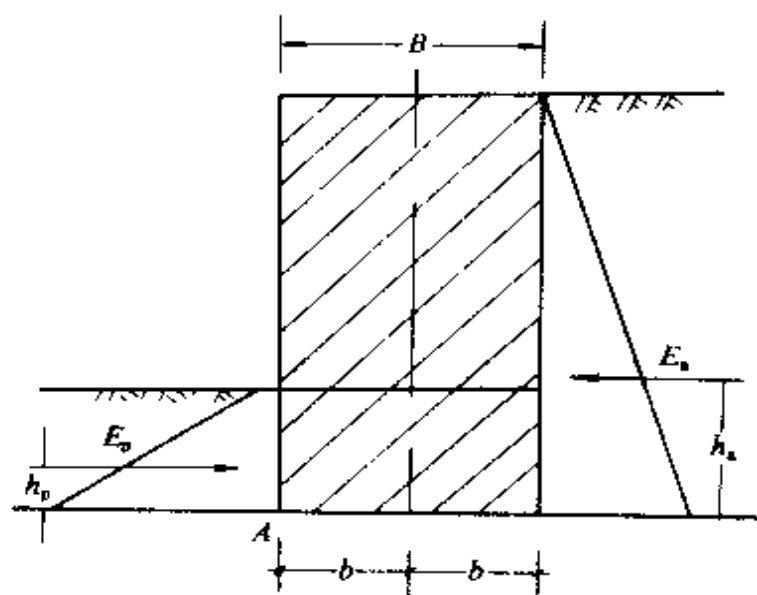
混凝土挡墙抗倾覆稳定性计算简图
